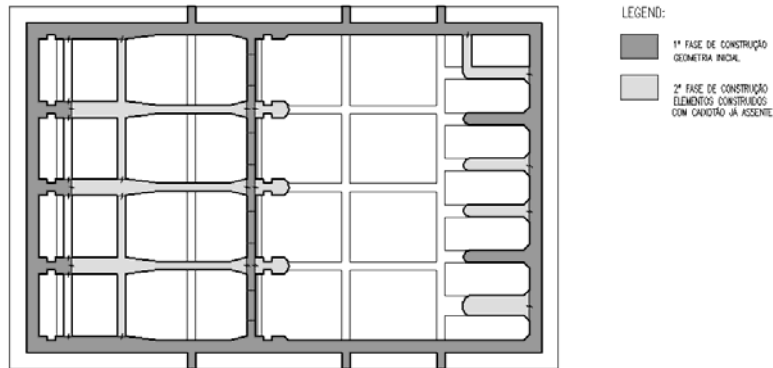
Faseamento construtivo dos elementos estruturais.
